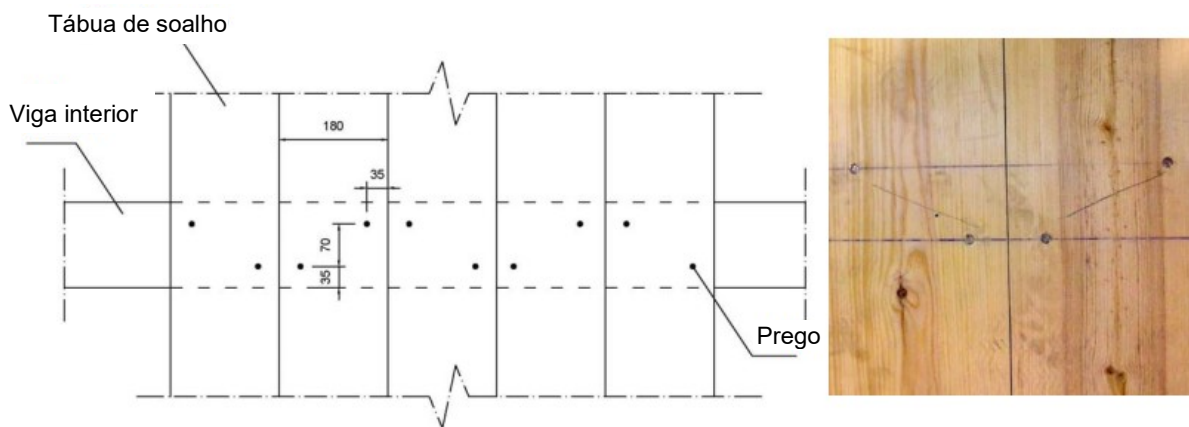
Esquema da disposição de pregos nas interseções entre as tábuas e as vigas interiores. (Dimensões em mm) (Fragomeli, 2015)
